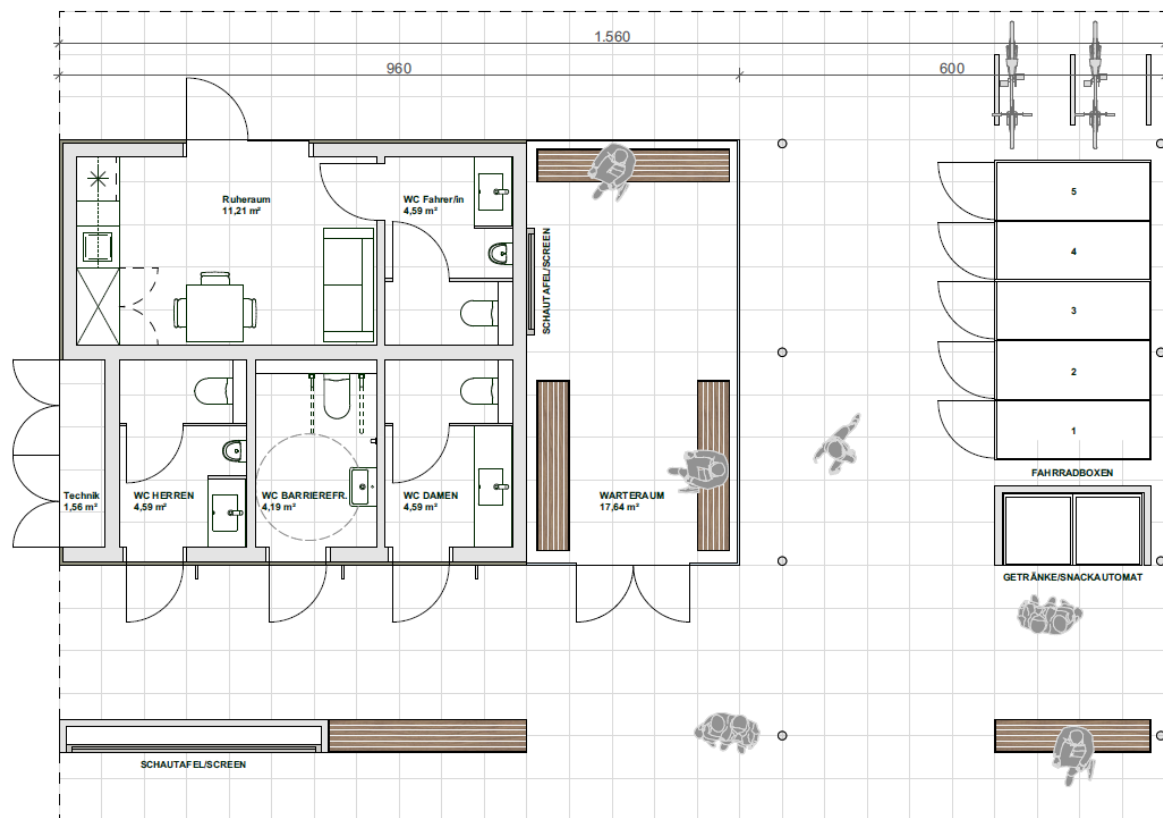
Grundriss Haltestelle Kat. XL © Landesimmobilien Burgenland
